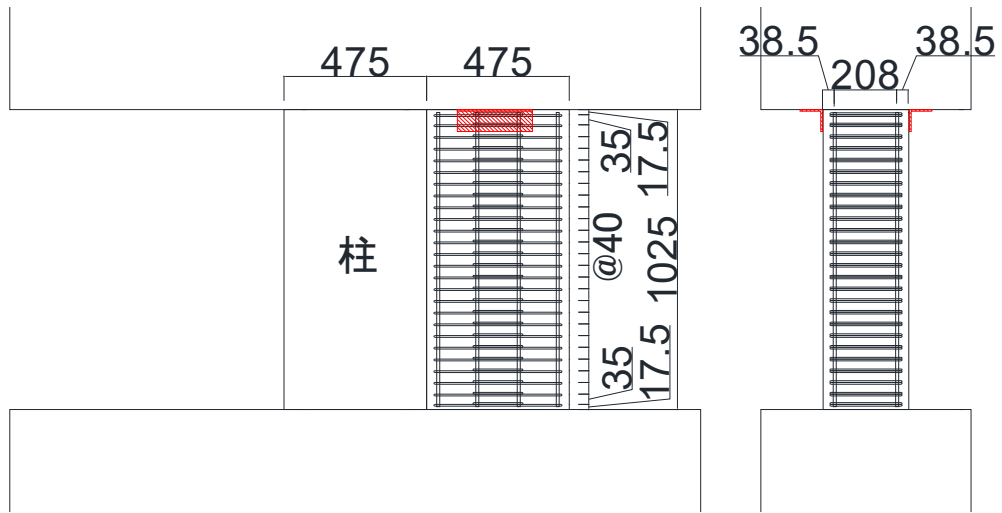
RC 壁部分 立面図 (左: 面内方向, 右: 面外方向) (単位: mm)
